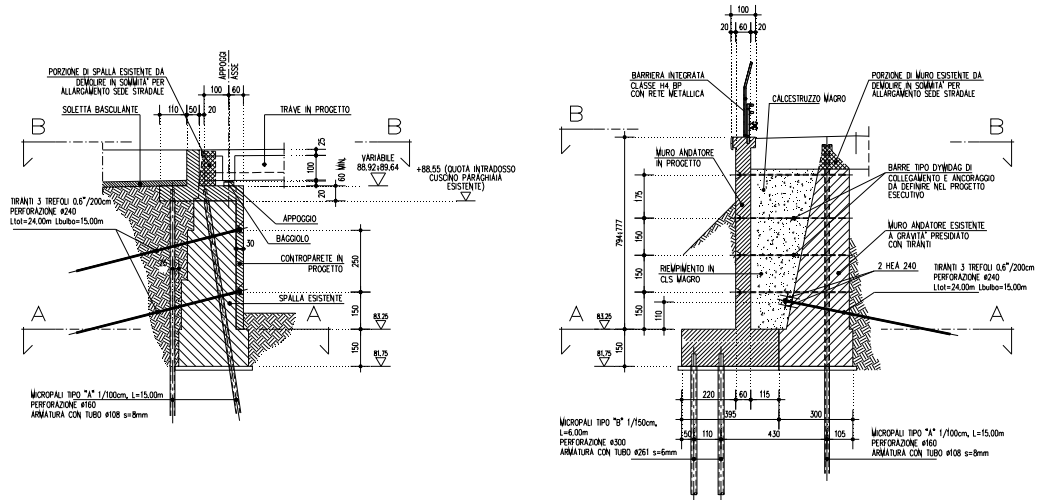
Sottovia NW01 - Sezione trasversale spalla e muro di risvolto
